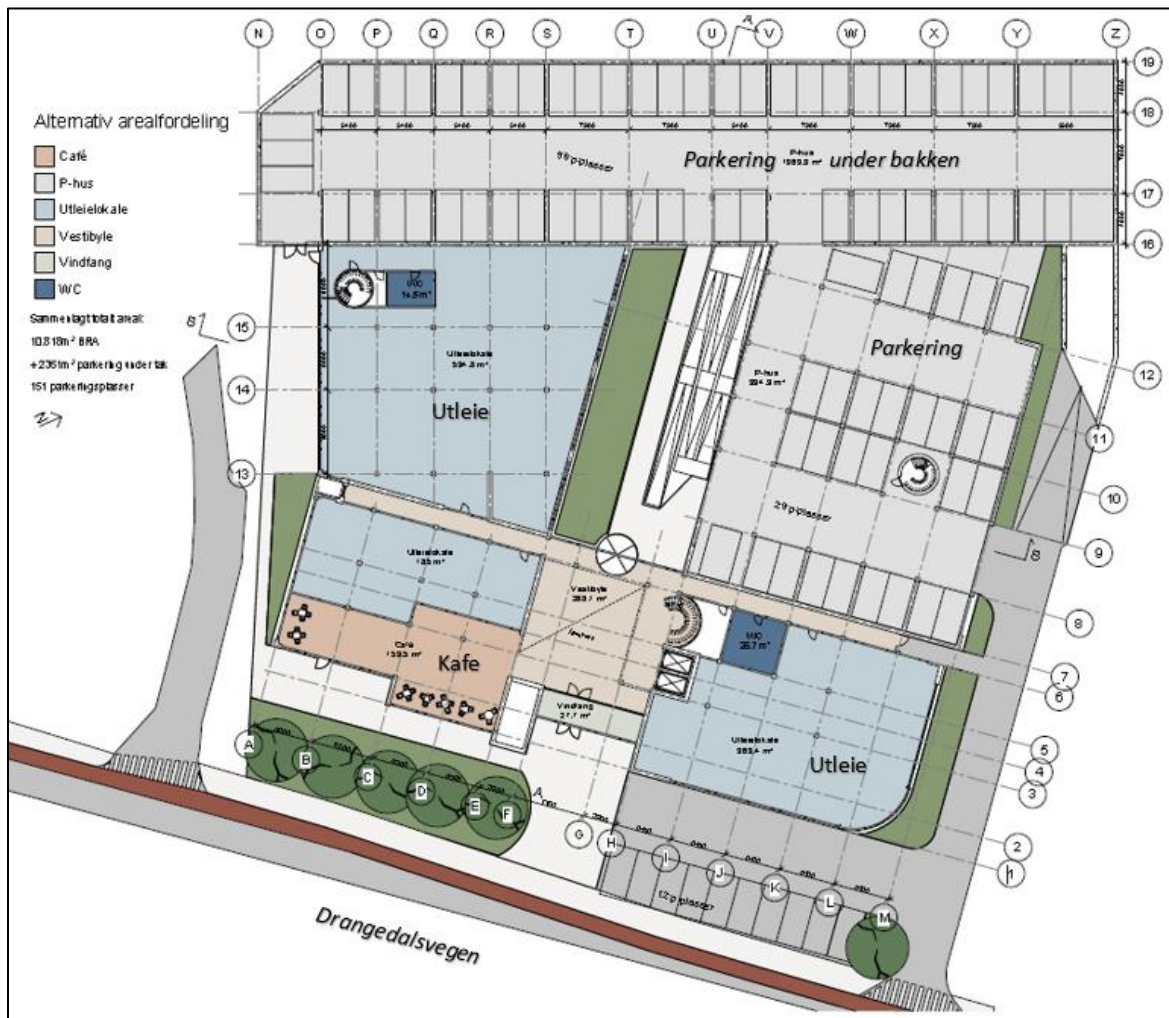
Fra mulighetsstudien: plan 1. etasje
